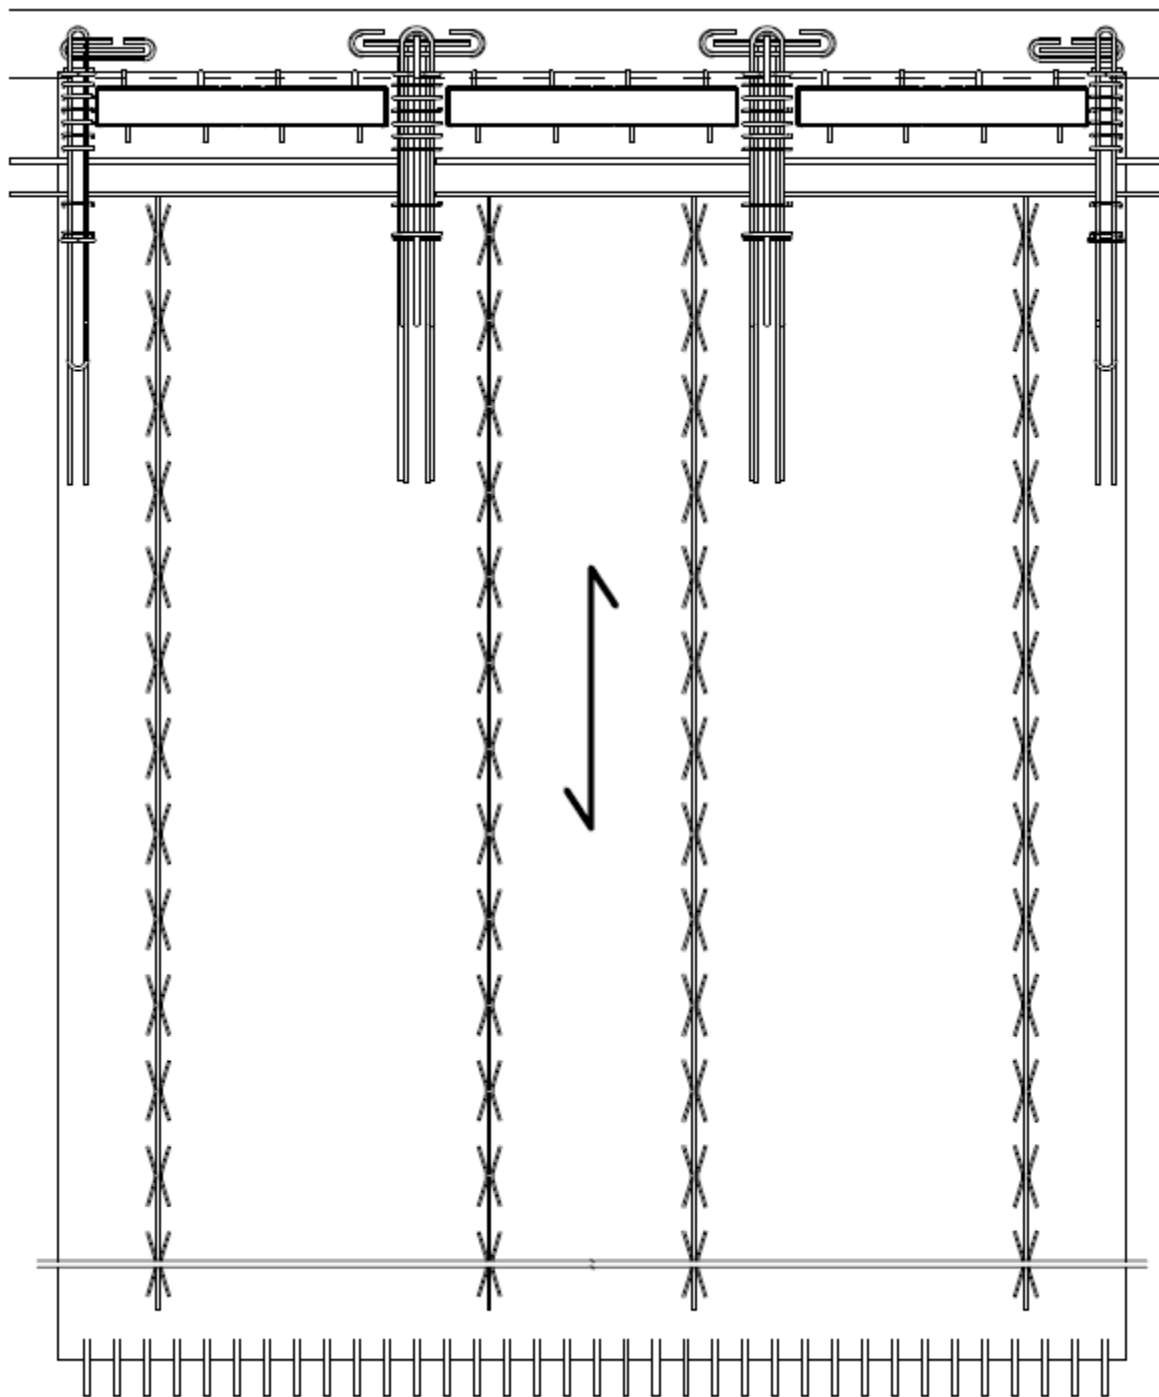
Cas de la prédalle d'about - Vue en plan – Coffrage
